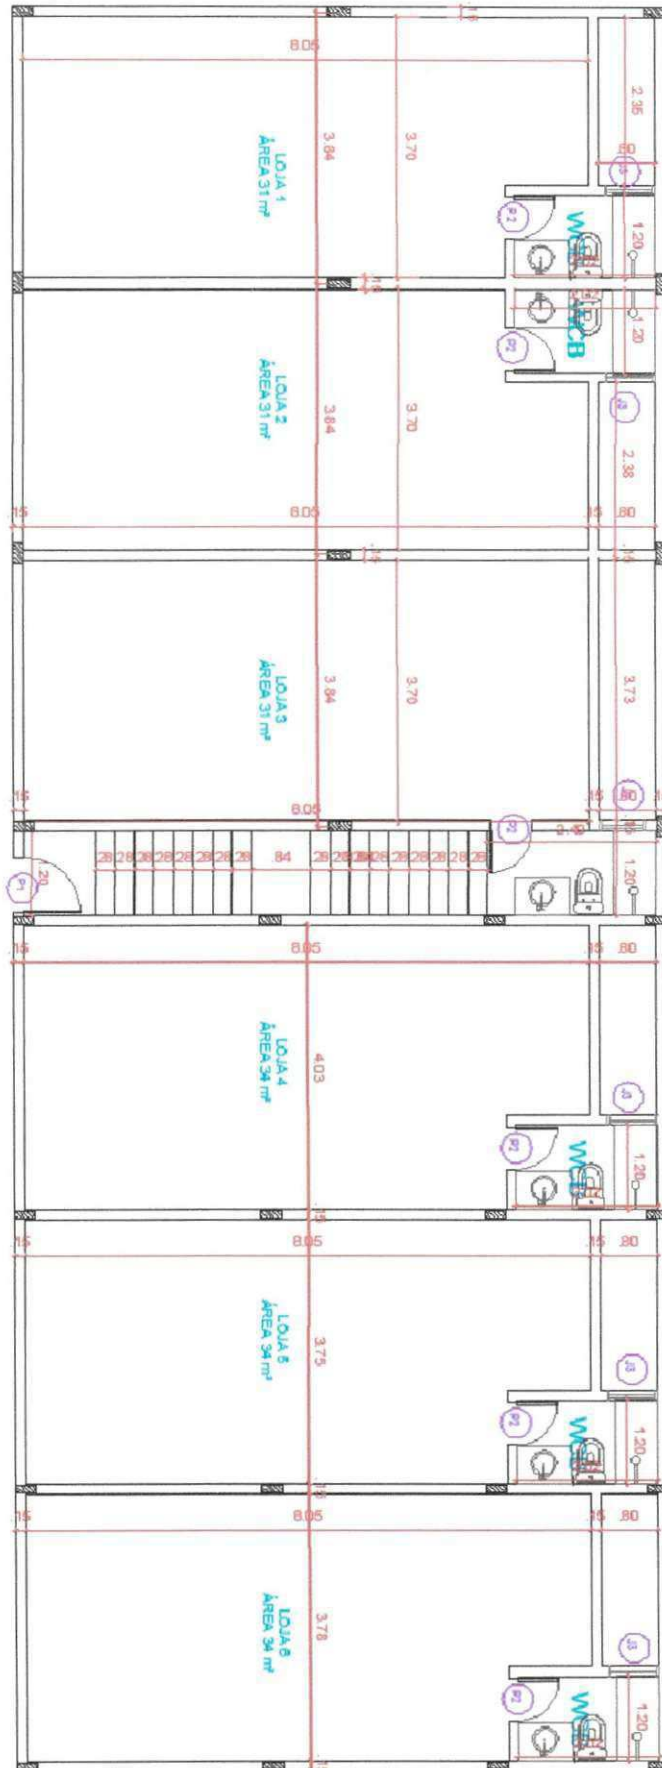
Planta baixa pavimento térreo edificação Banabeiras-PB
